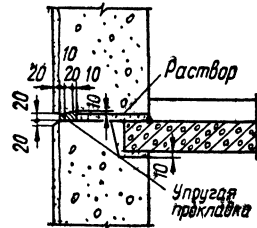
Горизонтальные стыки наружных стеновых панелей.
